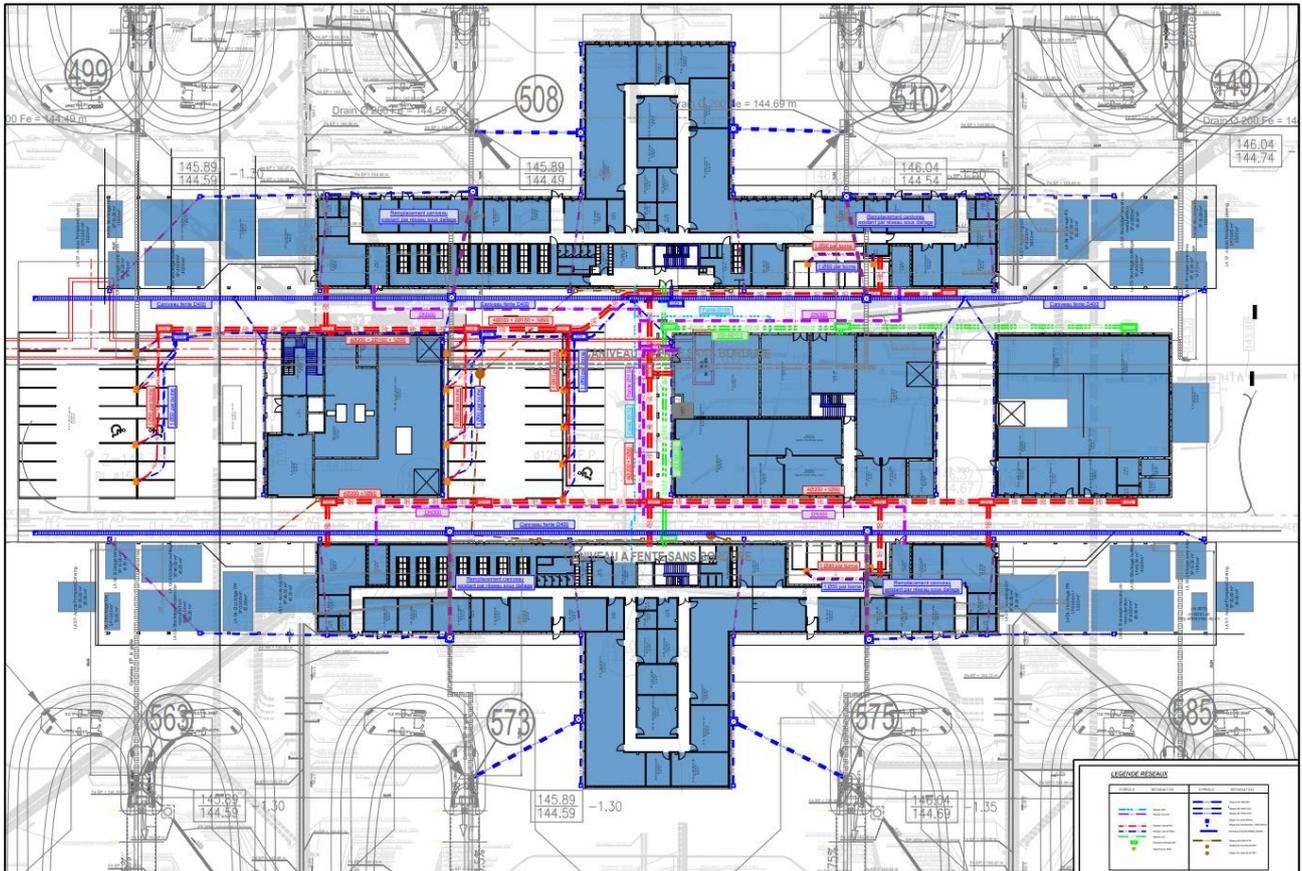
Plan du bâtiment central et des groupes de production du projet L14 sur le site Jean-Luc Lagardère
